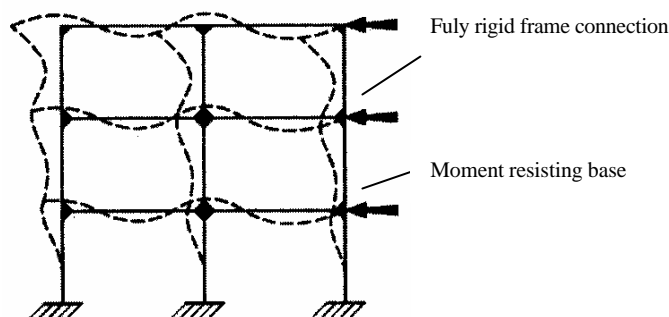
Configuração deformada de uma estrutura com ligações rígidas.
